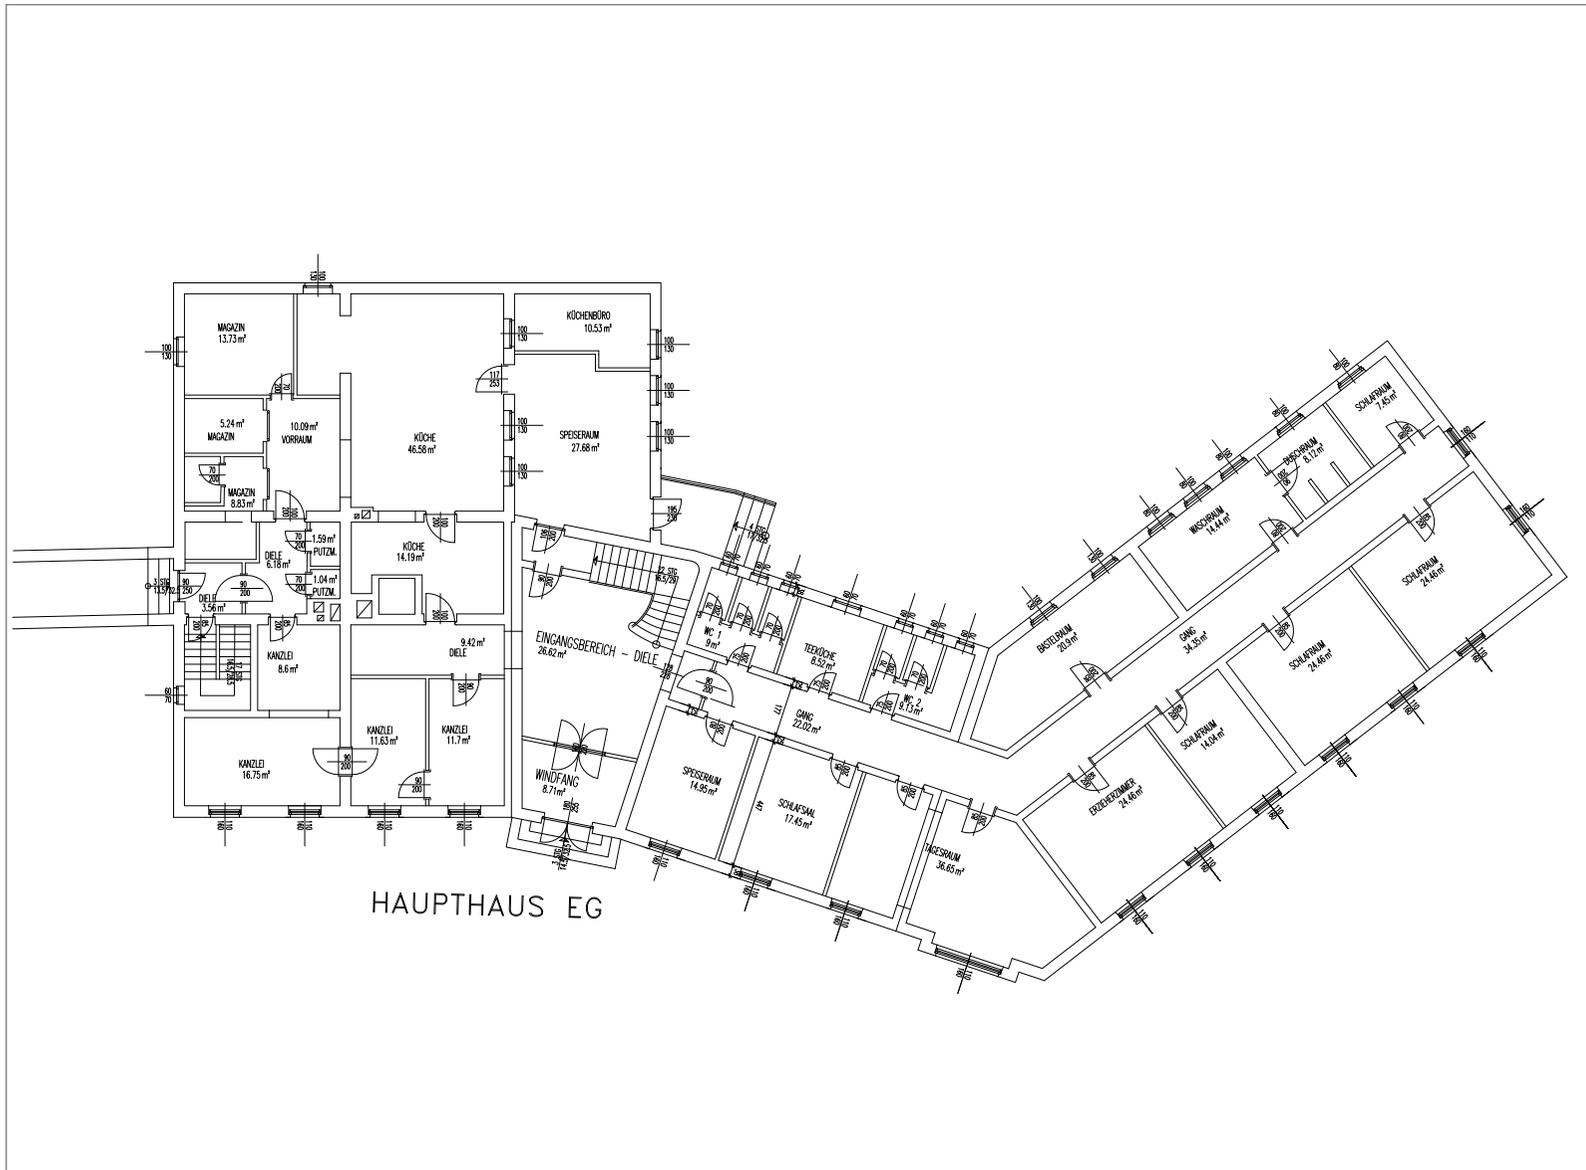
Grundriss des EGs des Haupthauses, ehemaliges LJH Rosenhof (Hartsleben 1999)
